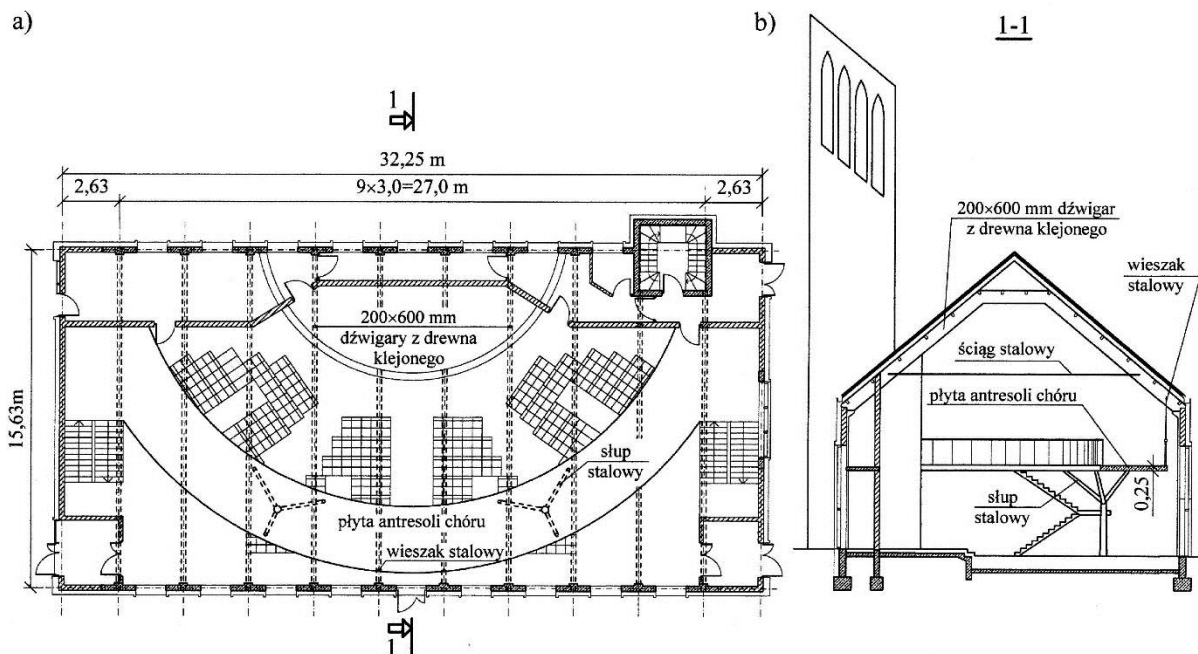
Rzut i przekrój konstrukcyjny budynku kościoła w Bodzanowie.
